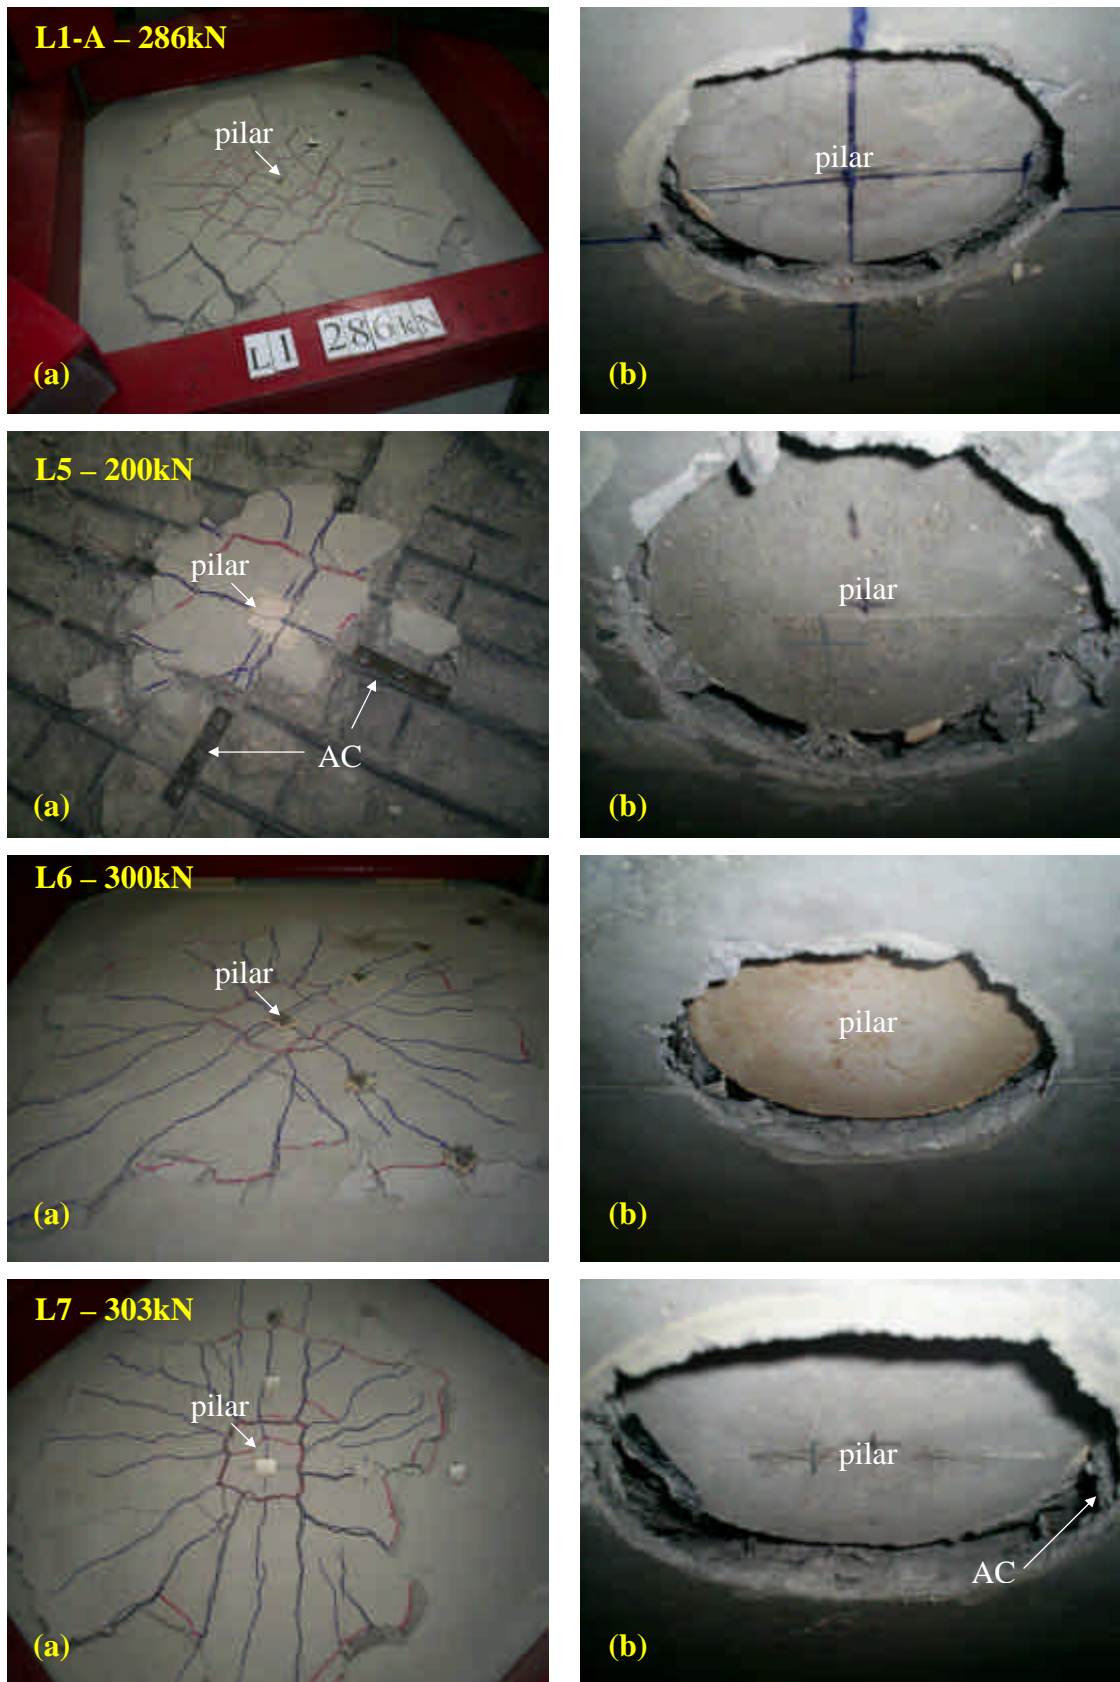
Fotografias das lajes L1-A, L5, L6 e L7 após a ruptura – (a) Vista superior;
